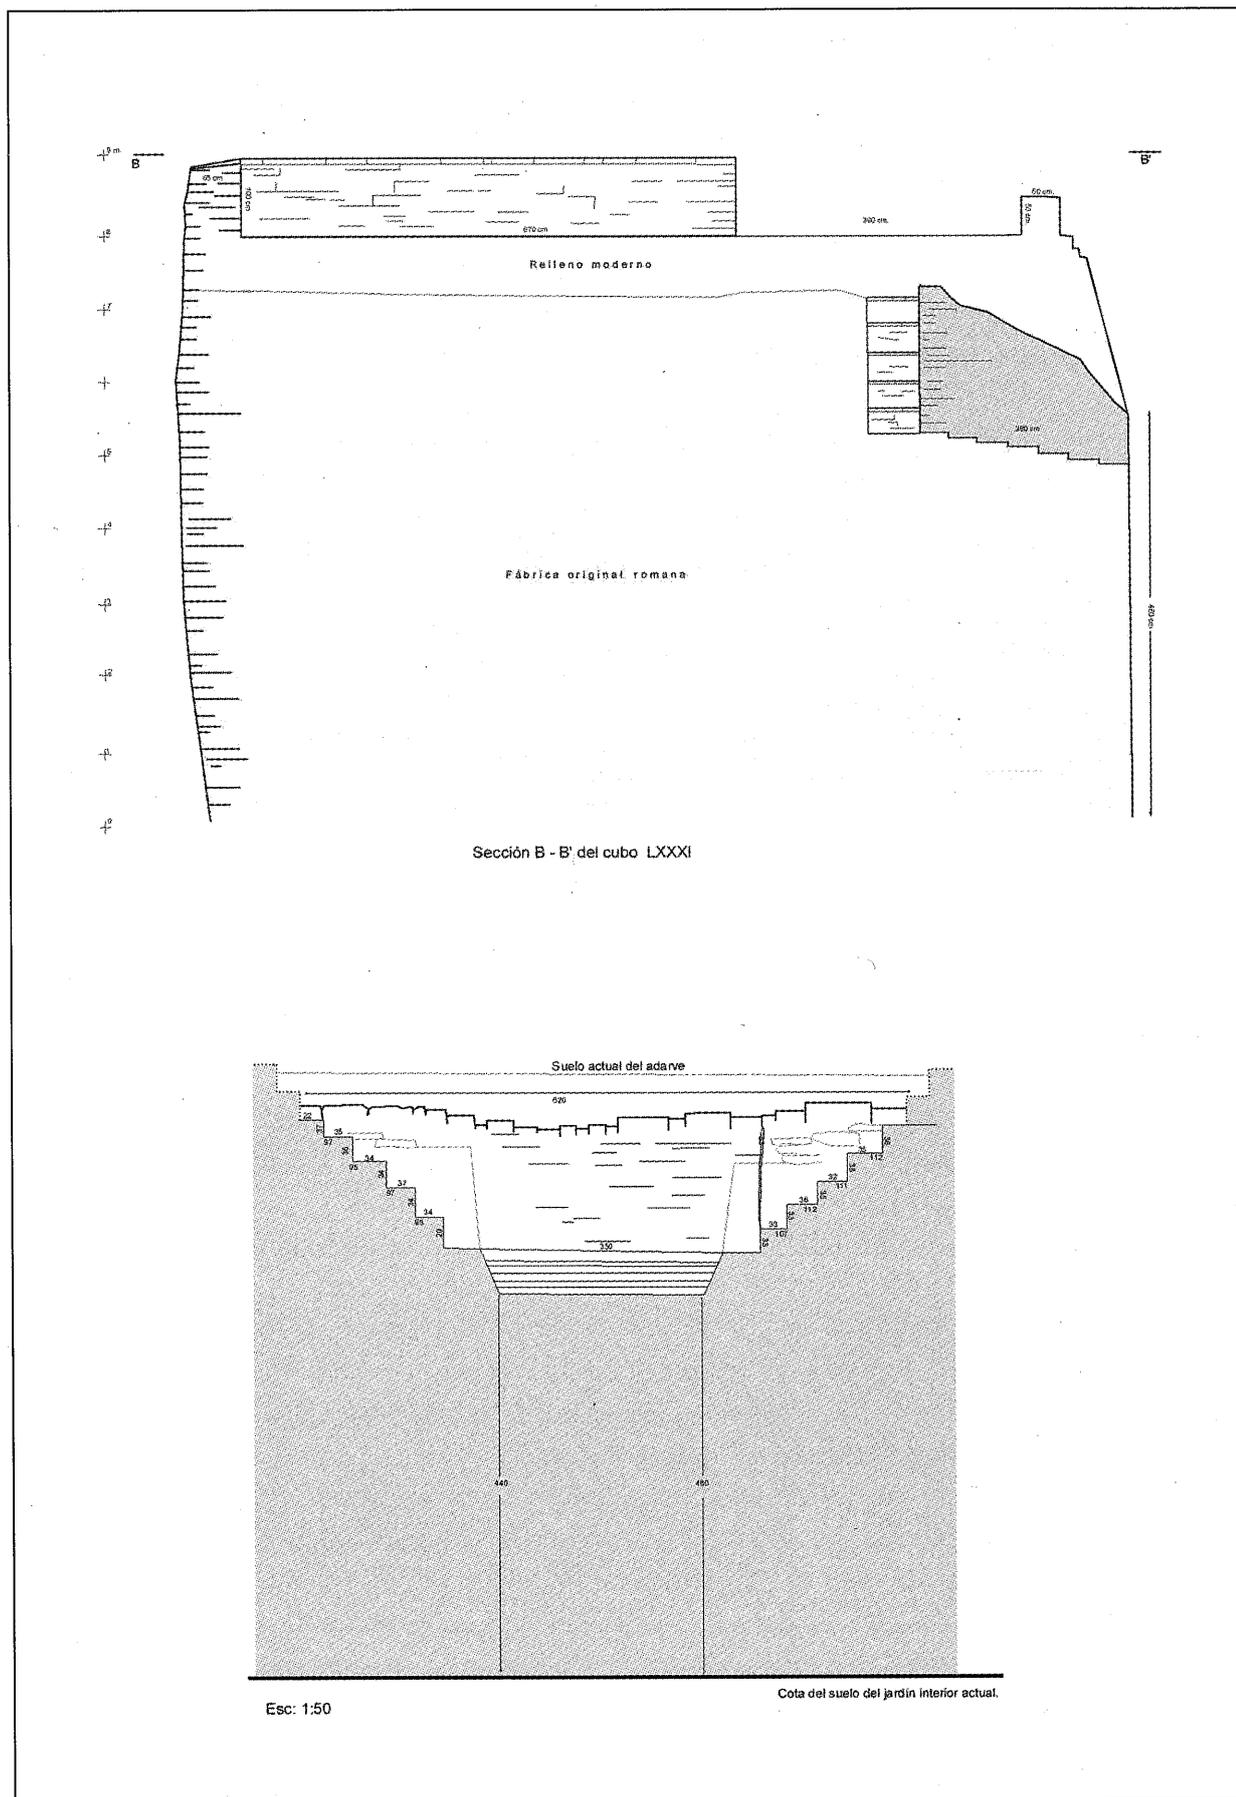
Sección longitudinal y alzado intrados del cubo LXXXI.
